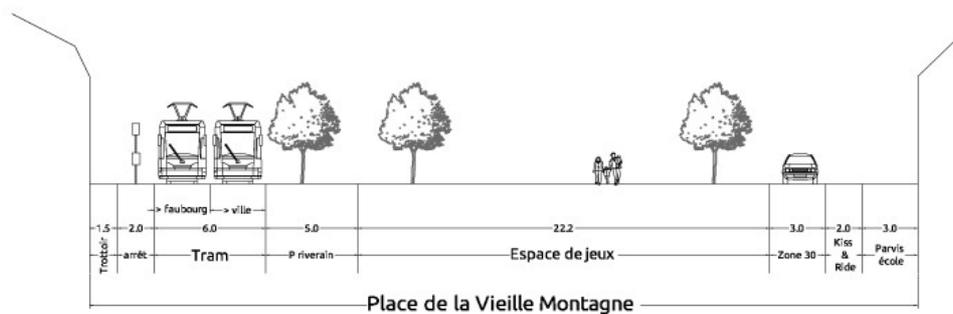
Coupe de l'implantation du tram sur la place Vieille Montagne
